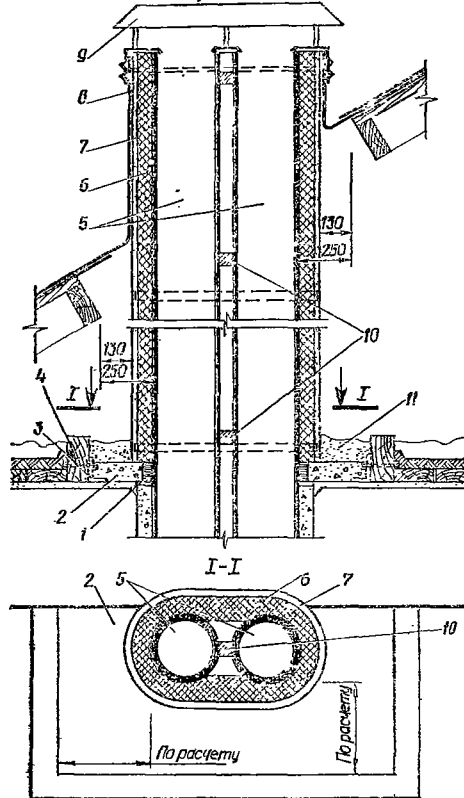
Устройство утепления асбестоцементных труб выше чердачного перекрытия:
